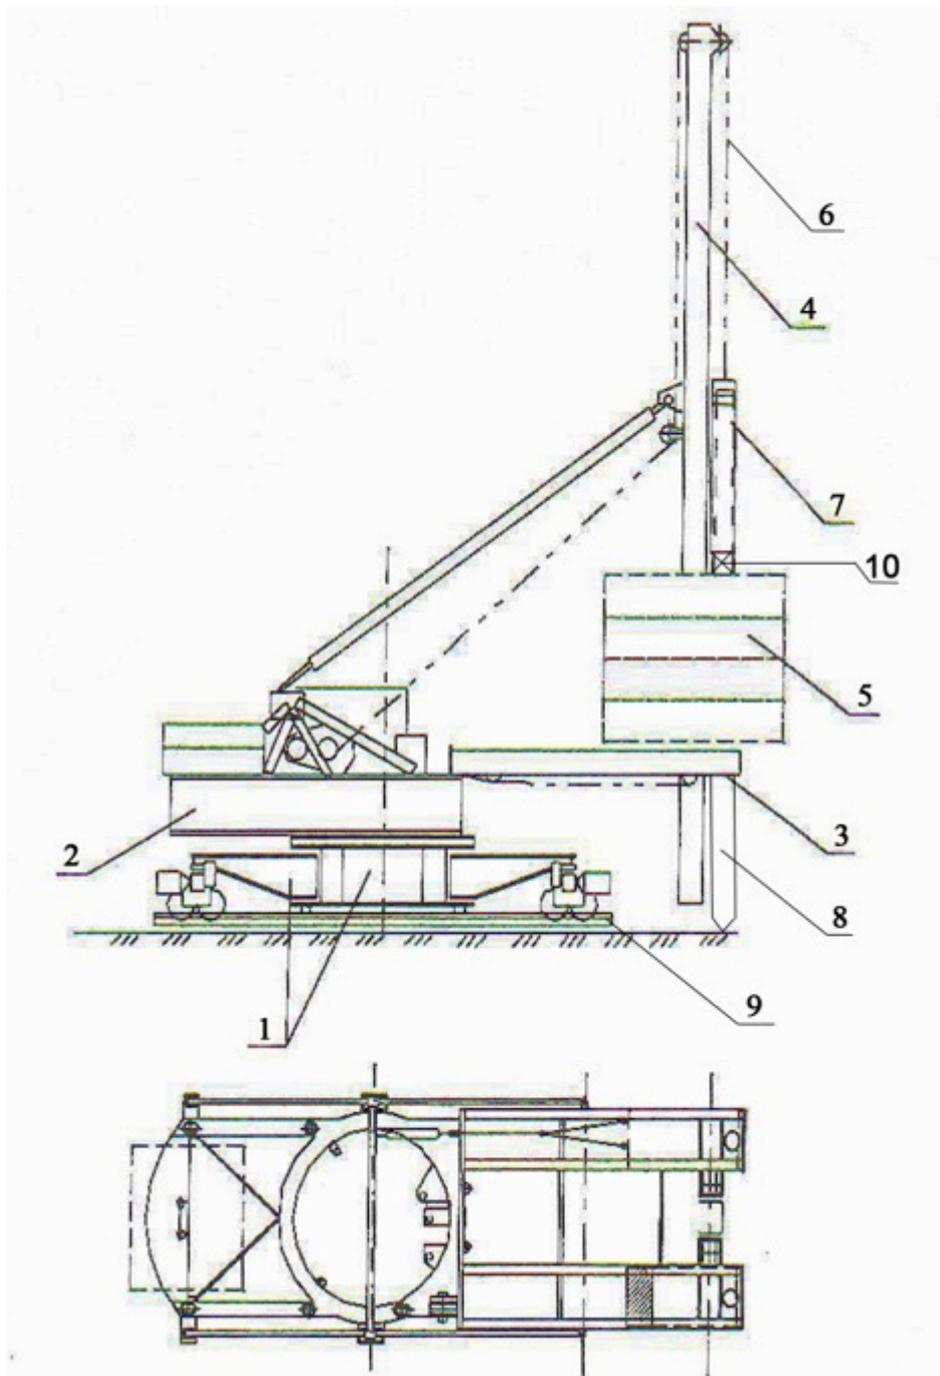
Основные конструктивные элементы сваедавливающей установки (СВУ) [1]:
